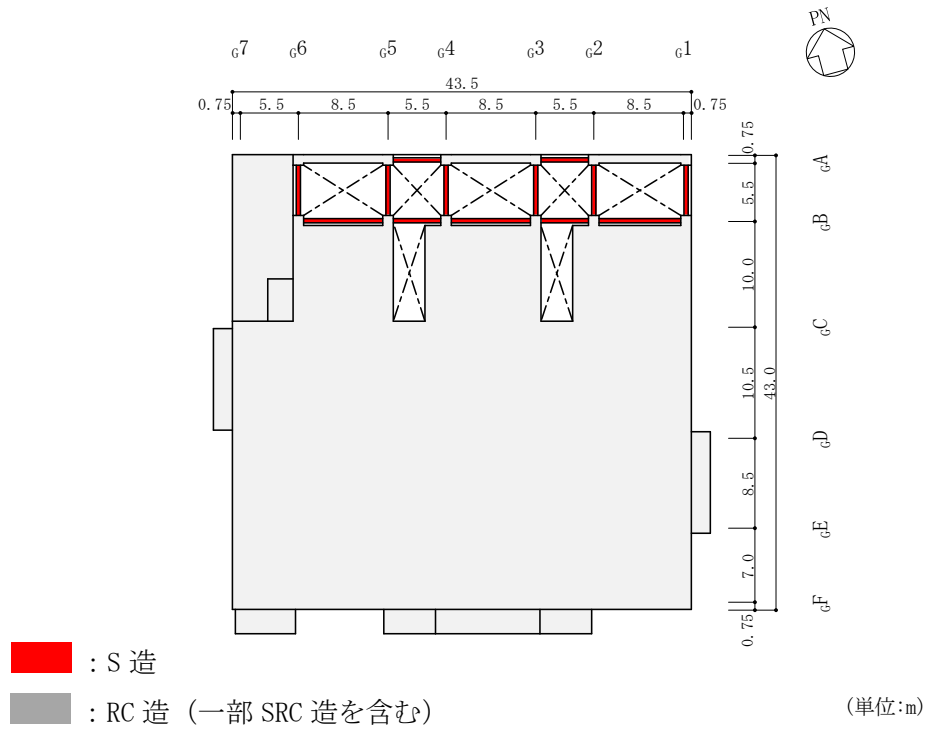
(3) ガスタービン発電機建物の概略平面図 (EL 61.5m)
